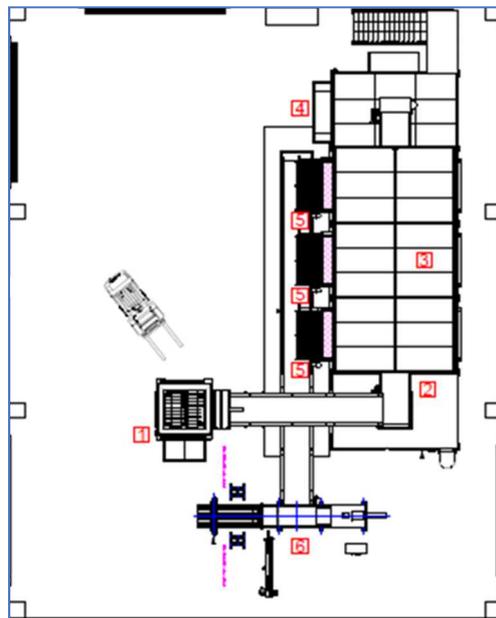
Planimetria Impianto di trattamento dei rifiuti
